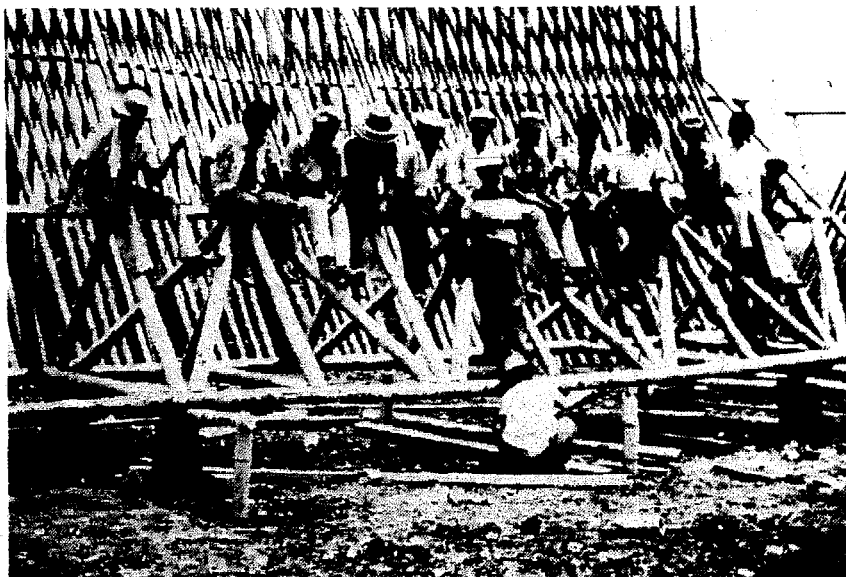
Ensayo de la primera armadura colocada entre soportes separados 6 metros.
